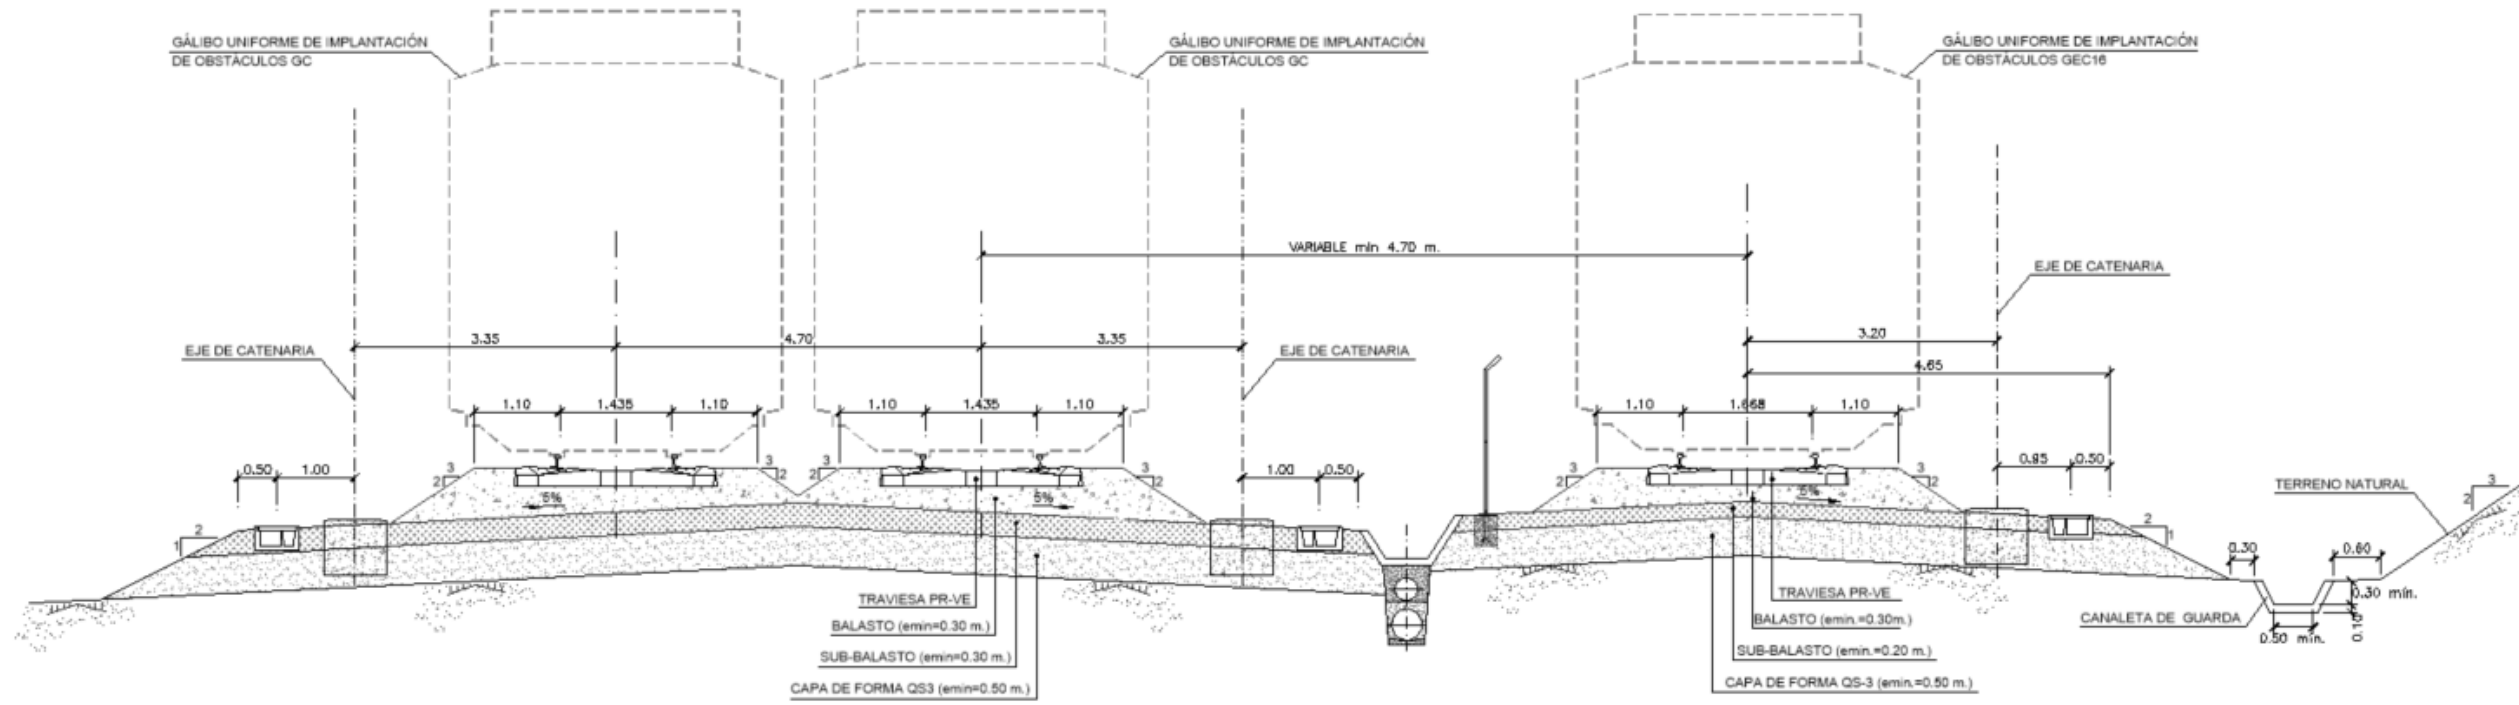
Sección tipo vía doble (ancho UIC + Ibérico)
